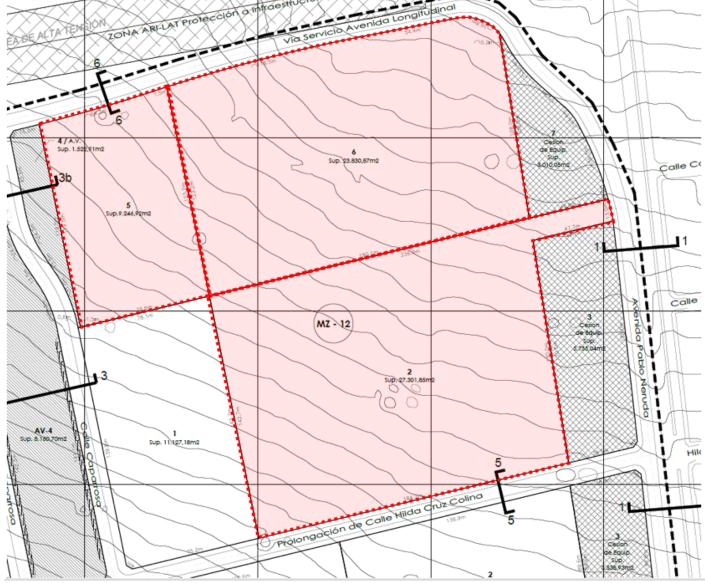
Ubicación Lotes 2, 5 y 6 de la MZ-12. Fuente: Extracto Plano Anteproyecto de Loteo Etapa II, Seremi MINVU.
